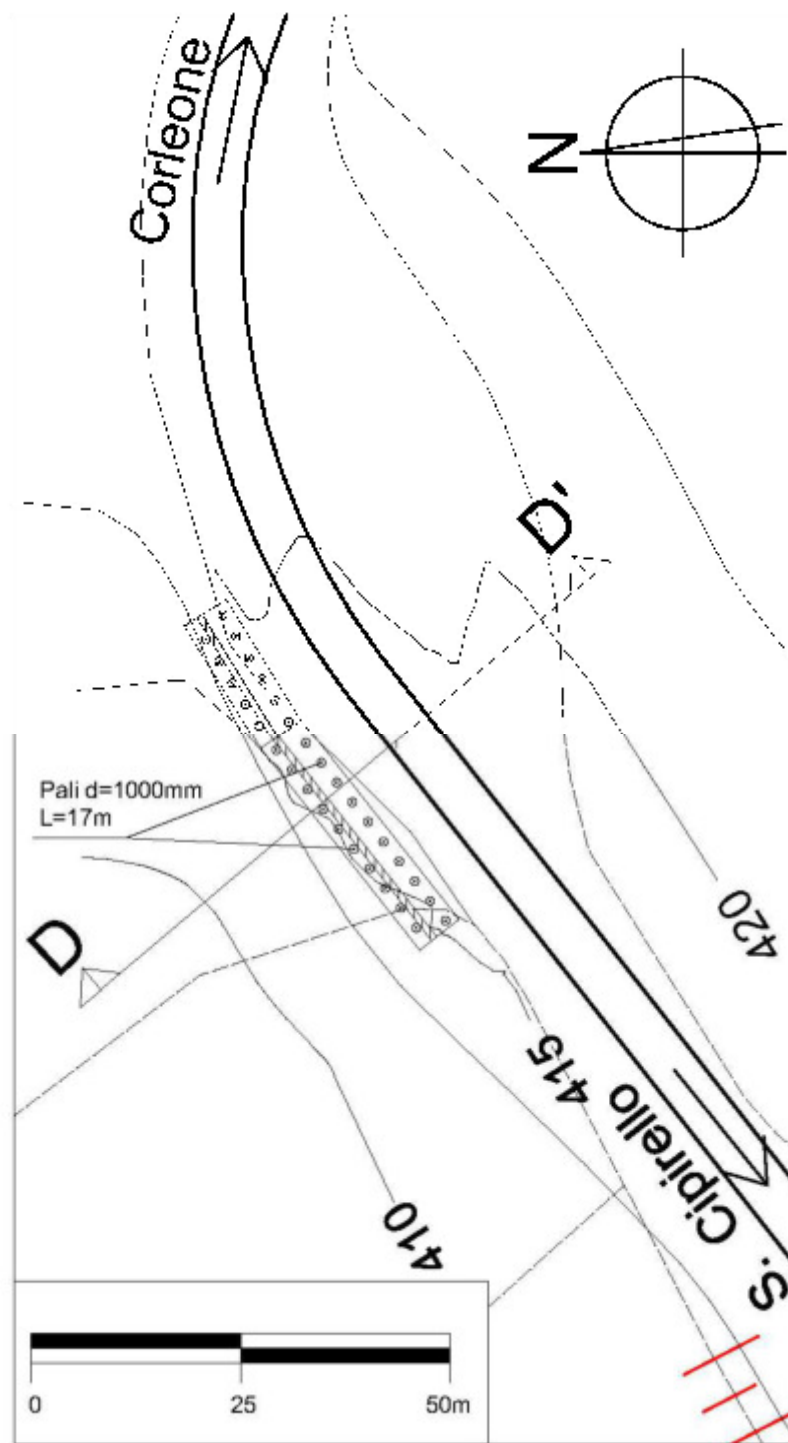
Dissesto al km 9+800. Planimetria schematica degli interventi da realizzare.
